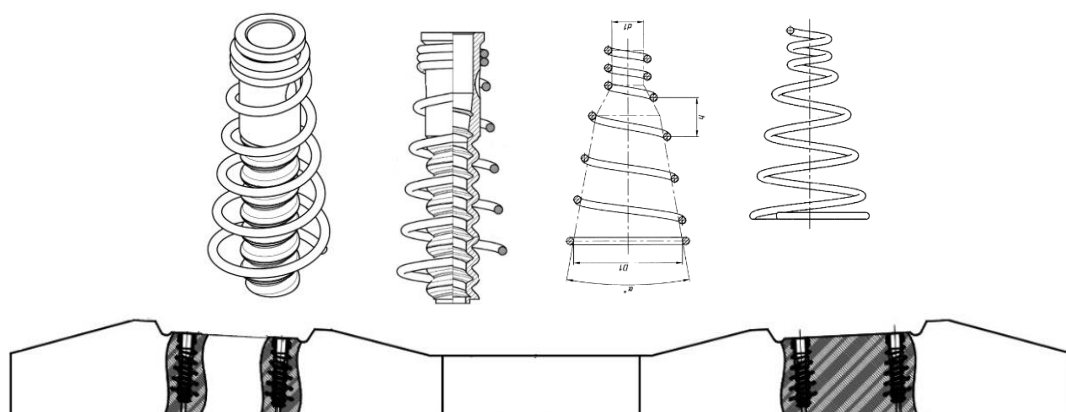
Локальное армирование бетона шпалы в зоне замоноличивания дюбеля
